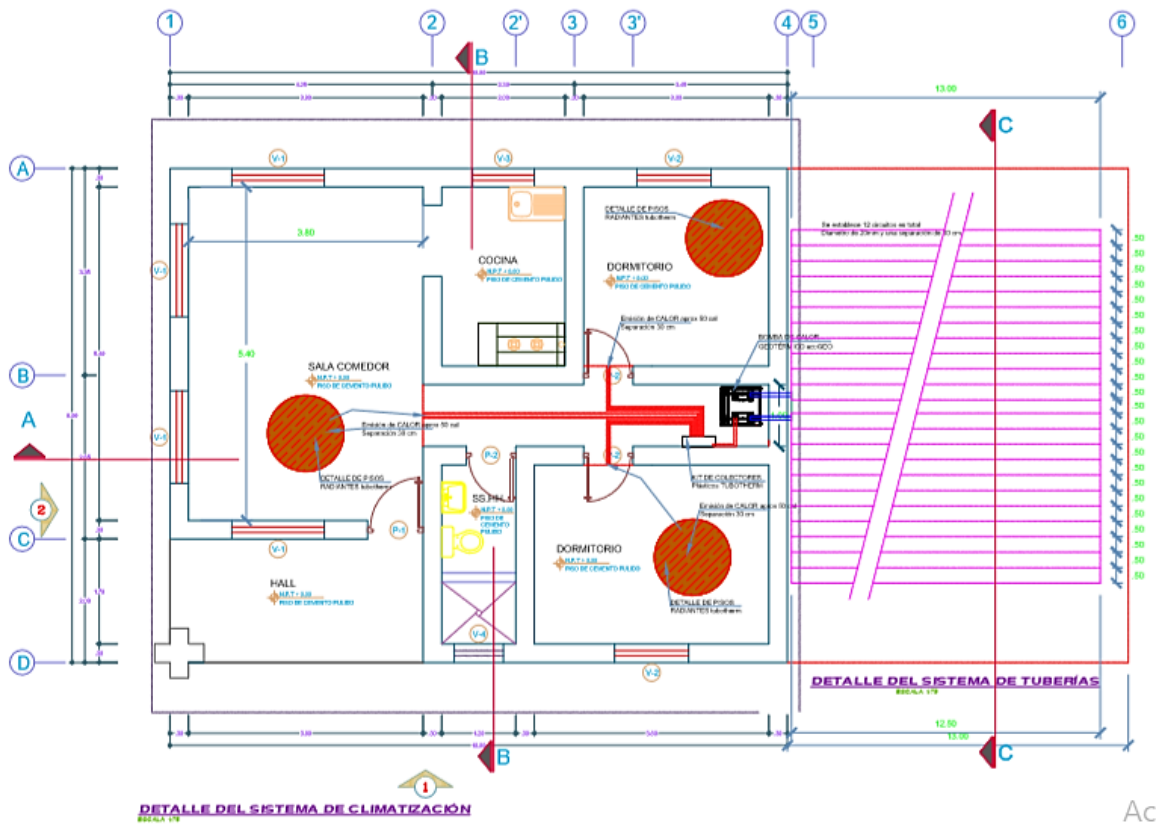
Plano con detalles de la instalación del suelo radiante, Escala 1/75
